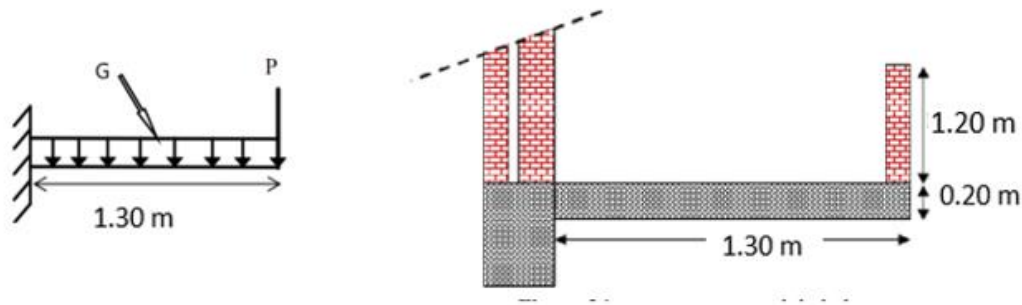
Schéma statique et coupe transversal du balcon.
